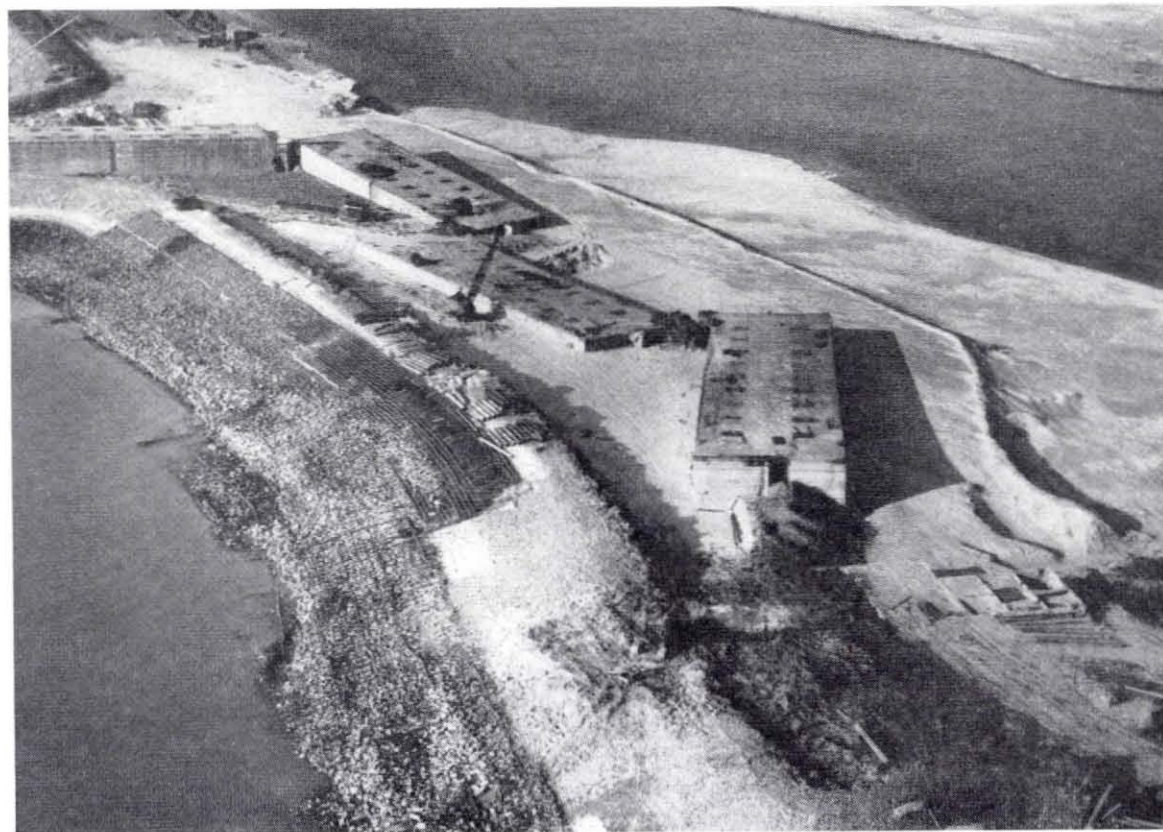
Afwerking van de dijk ten zuiden van Ouwerkerk ter plaatse van de blokkering met vier Phoenixcaissons. Ten noorden van de caissondam is een breed strand gespoten. Aan de zuidzijde is op de kleibekleding een rijsbeslag met steen aangebracht.
